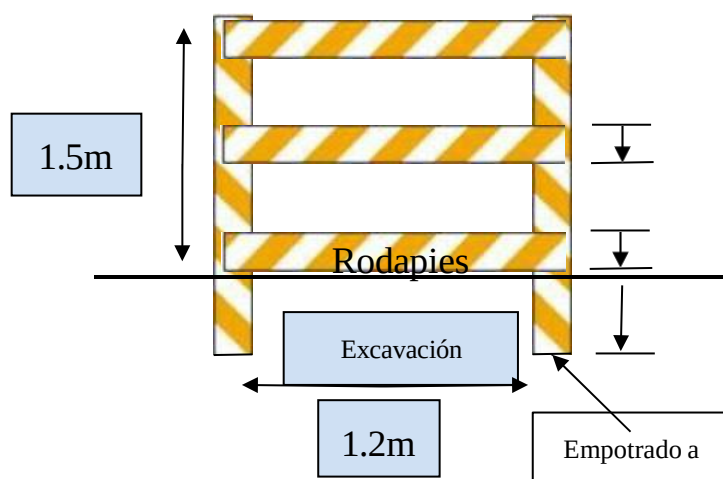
Cerco rígido metálico empotrado a la excavación que permanece más de 24 horas abierta (TN terreno natural).
